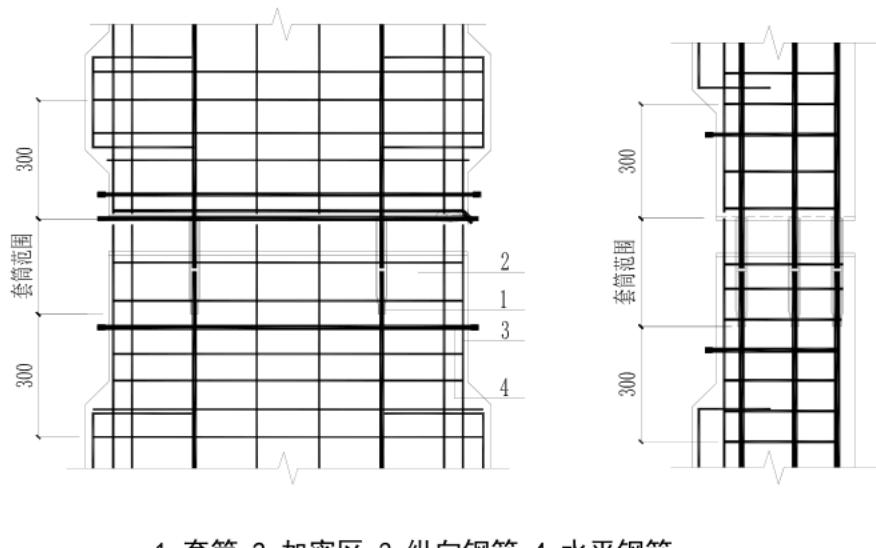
钢筋套筒灌浆连接部位的水平分布钢筋加密构造
